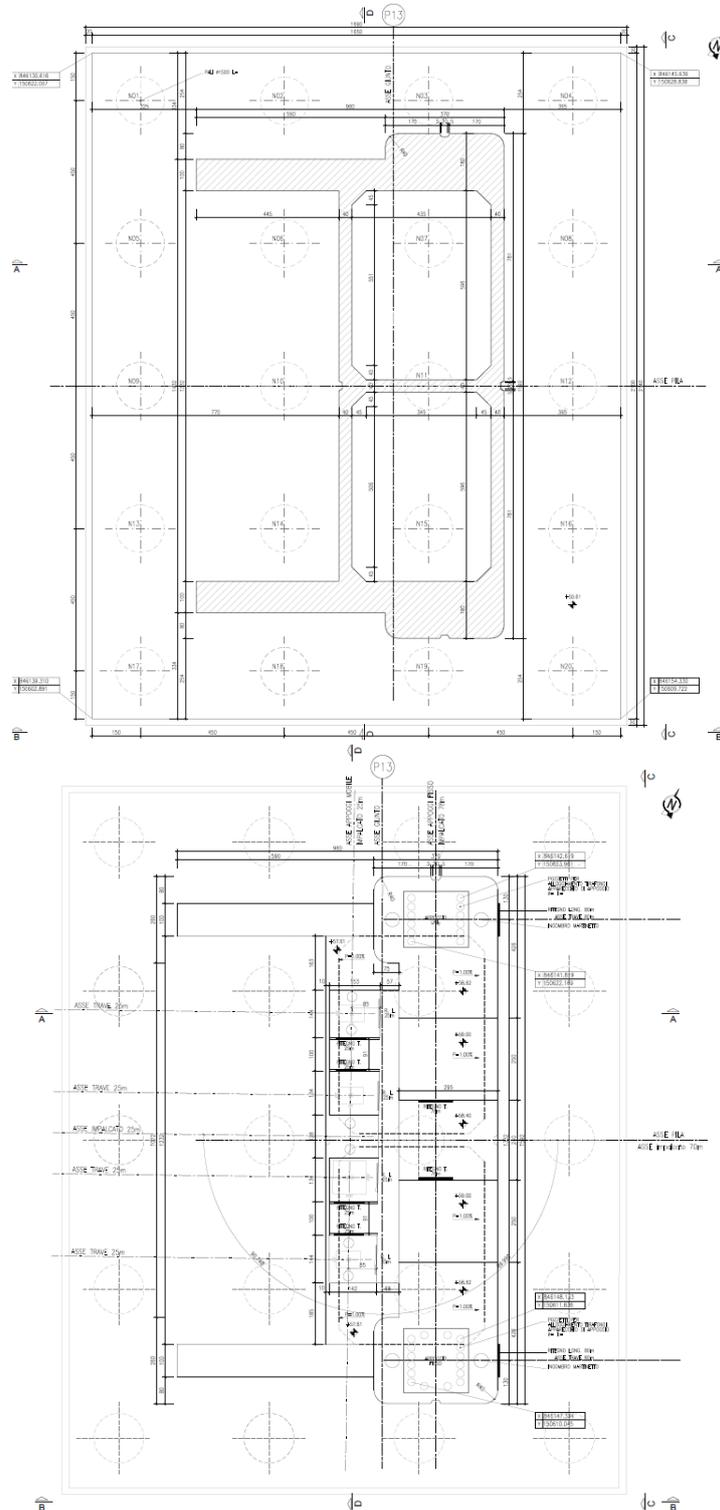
Pianta fondazioni (a sinistra) e pianta pulvino (a destra)
